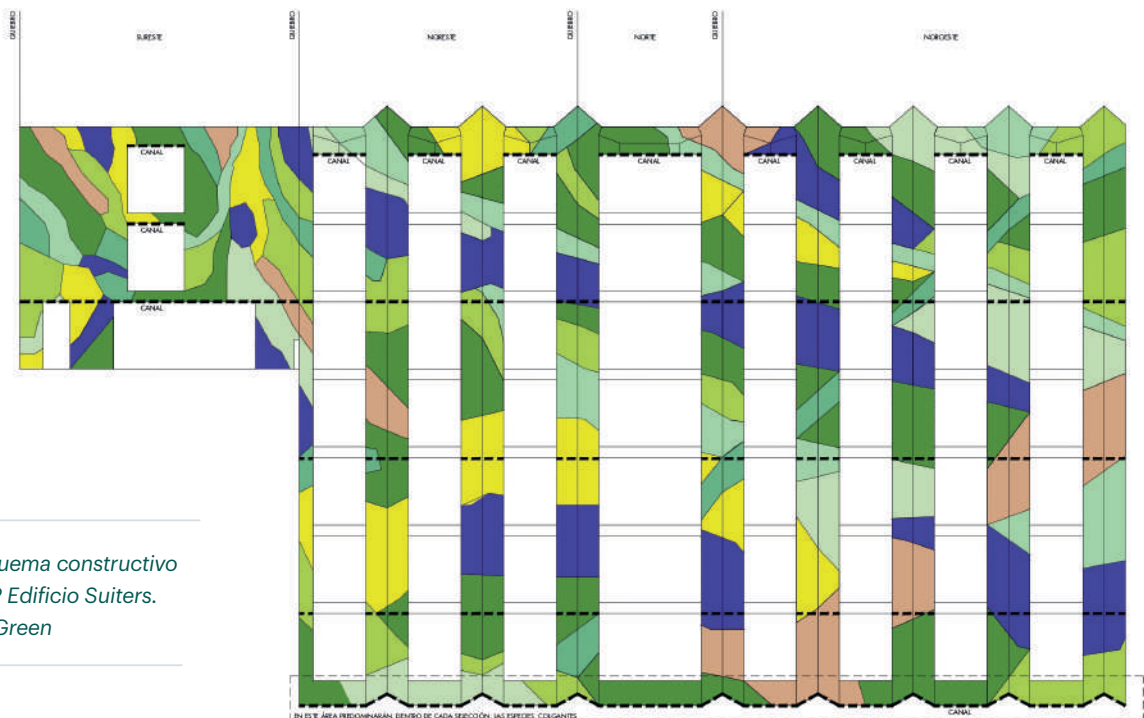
Esquema constructivo jardín vertical F+P Edificio Suiters.
